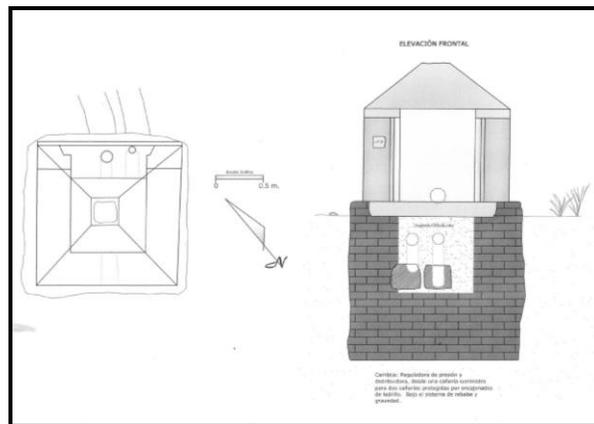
Planta y elevación frontal de Caja de distribución o columnaria.
